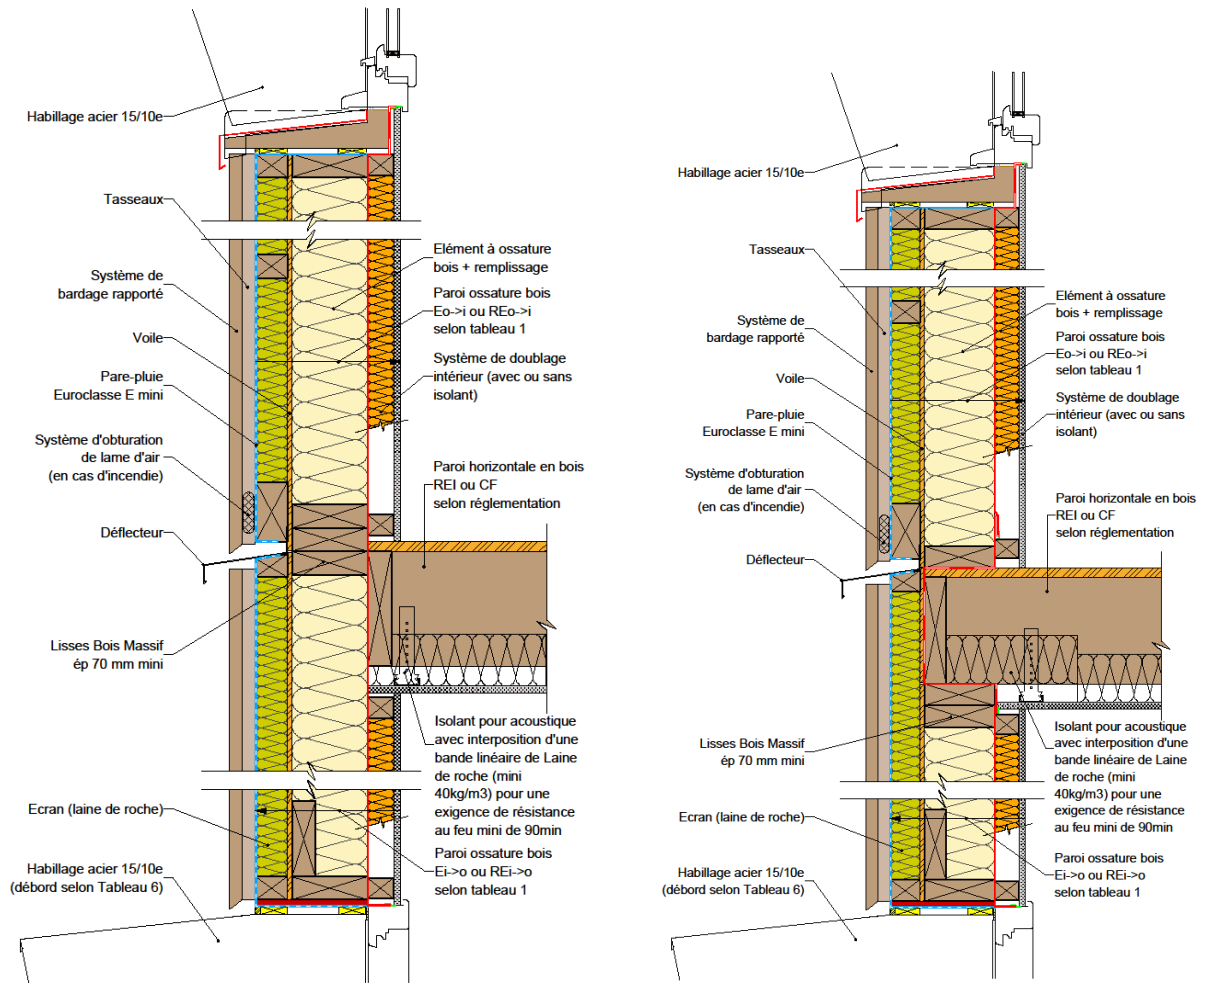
Façade/mur en ossature bois & plancher en ossature bois.
